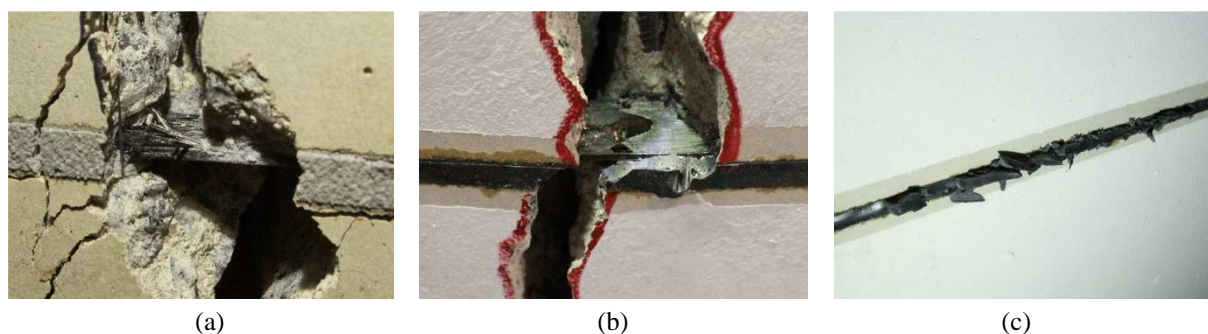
Modos de rotura: (a) rotura do laminado de CFRP (lajes reforçadas com os adesivos ADH1 e ADH2); (b) deslizamento do laminado (lajes reforçadas com o adesivo ADH3); (c) desagregação do adesivo na extremidade (lajes reforçadas com o adesivo ADH3).
